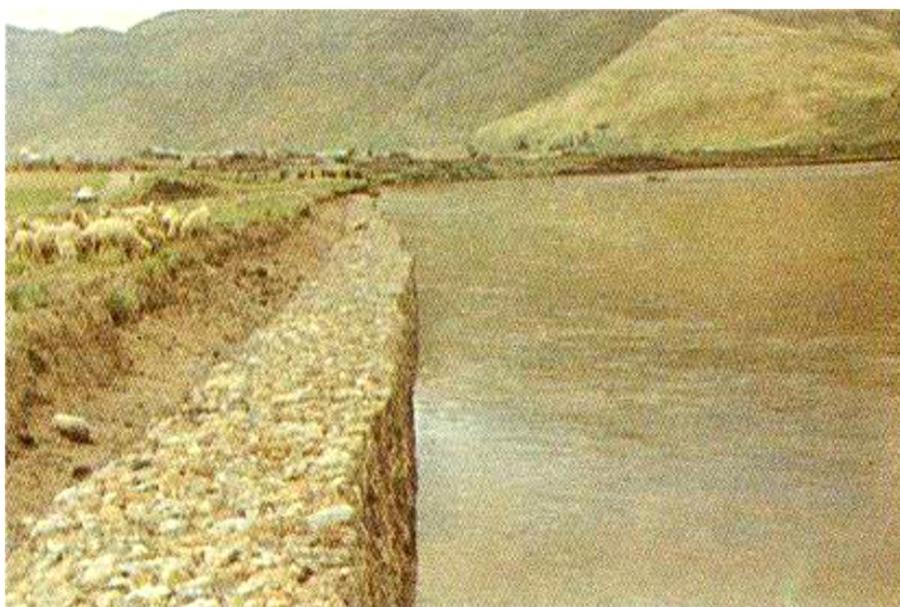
Ejemplo de muro longitudinal para el encauzamiento del río.
